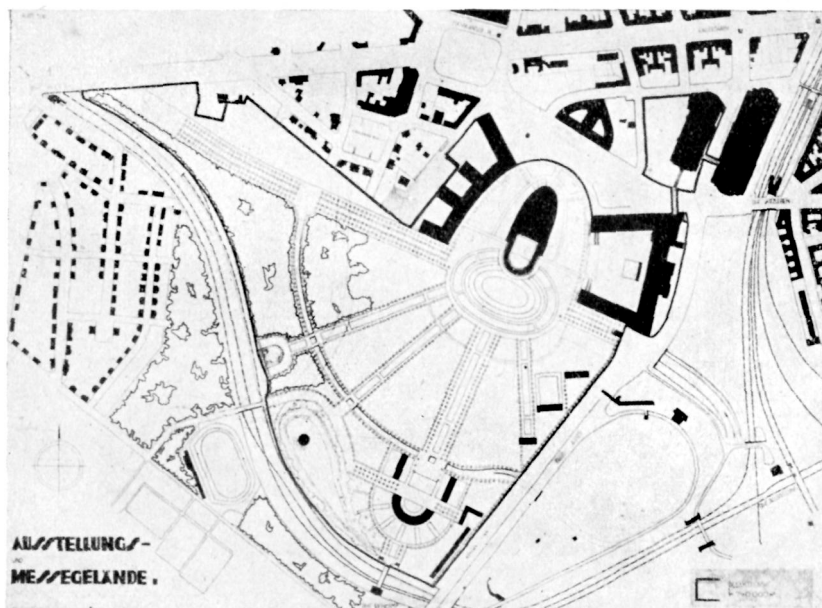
Neuer reduzierter Bebauungsvorschlag¹⁾. Lageplan
